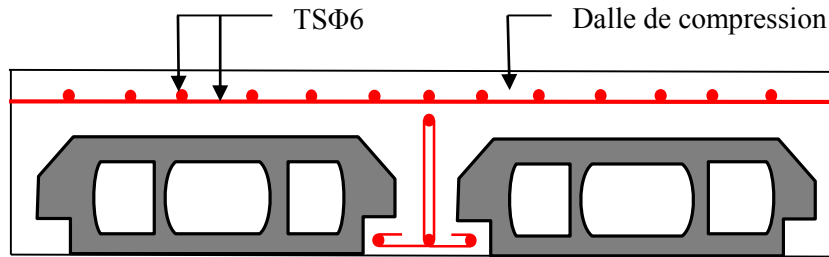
Schéma de ferrailage de la dalle de compression.
